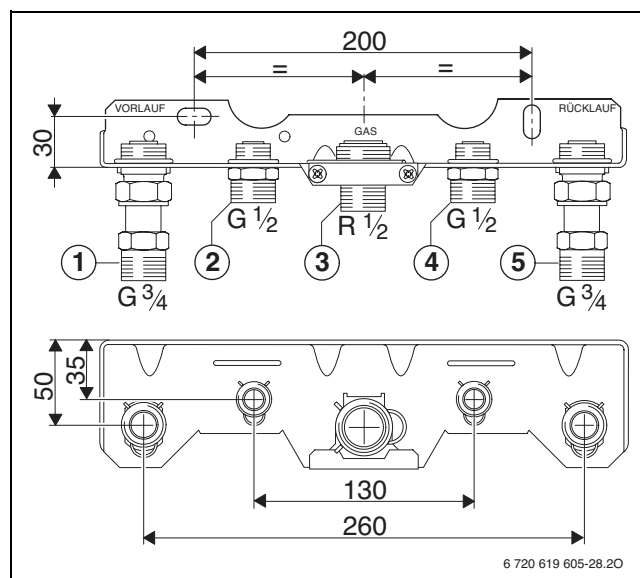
Exemplu: placa de racord pentru montaj U-MA
